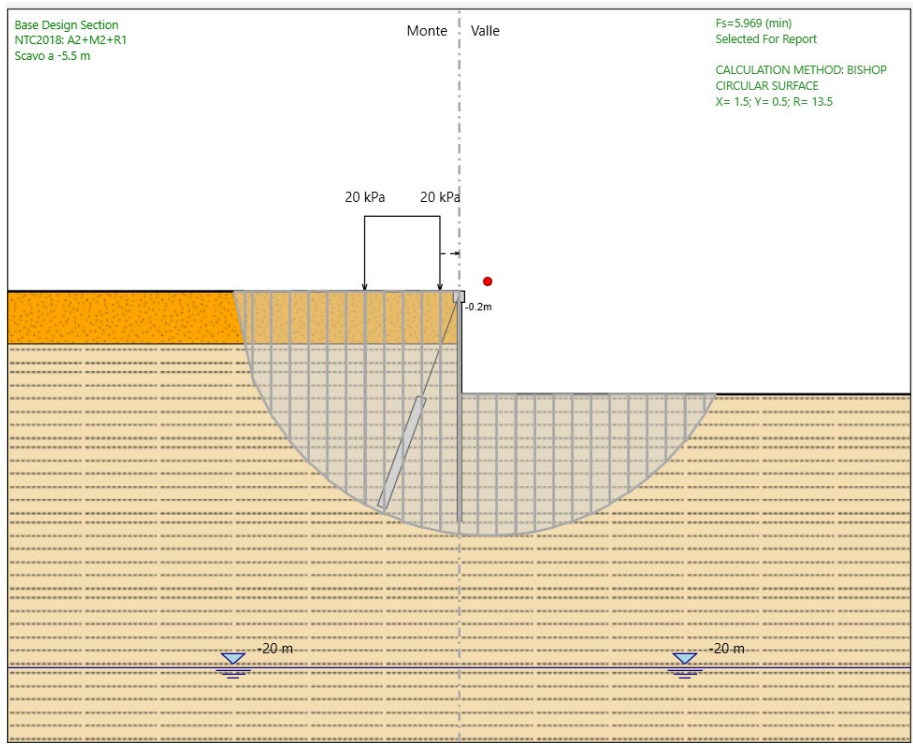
Sezione Tipo B1 - Condizioni statiche (FS=6.0)
